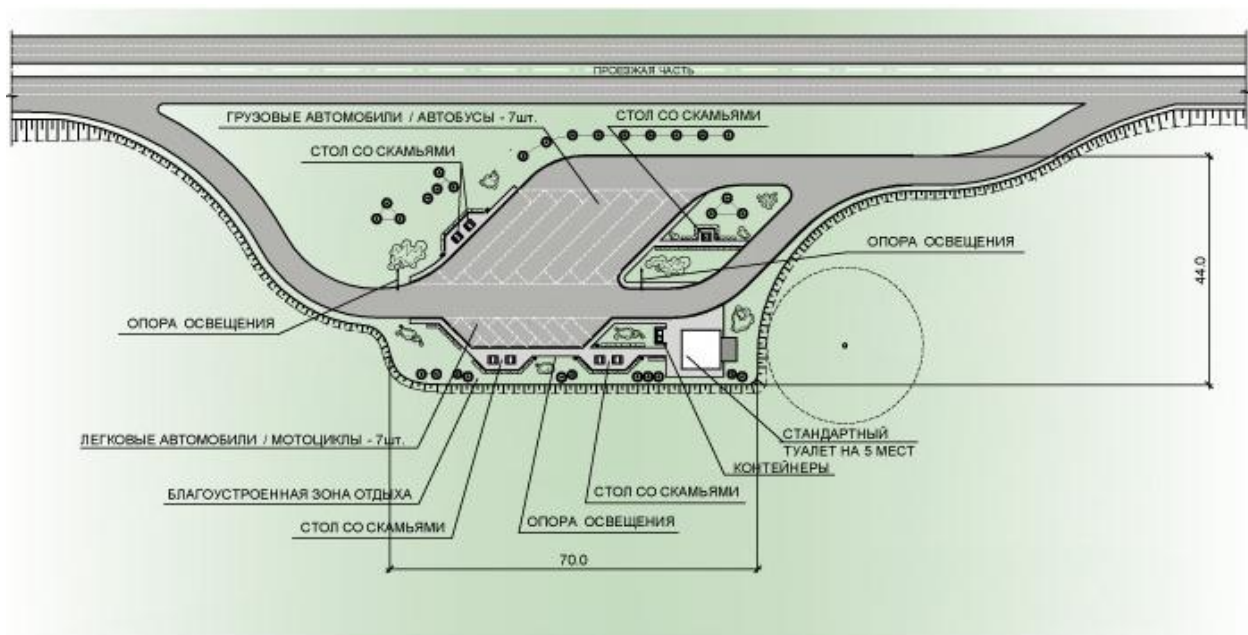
Пример (схема) размещения площадки для отдыха в границах полосы отвода
